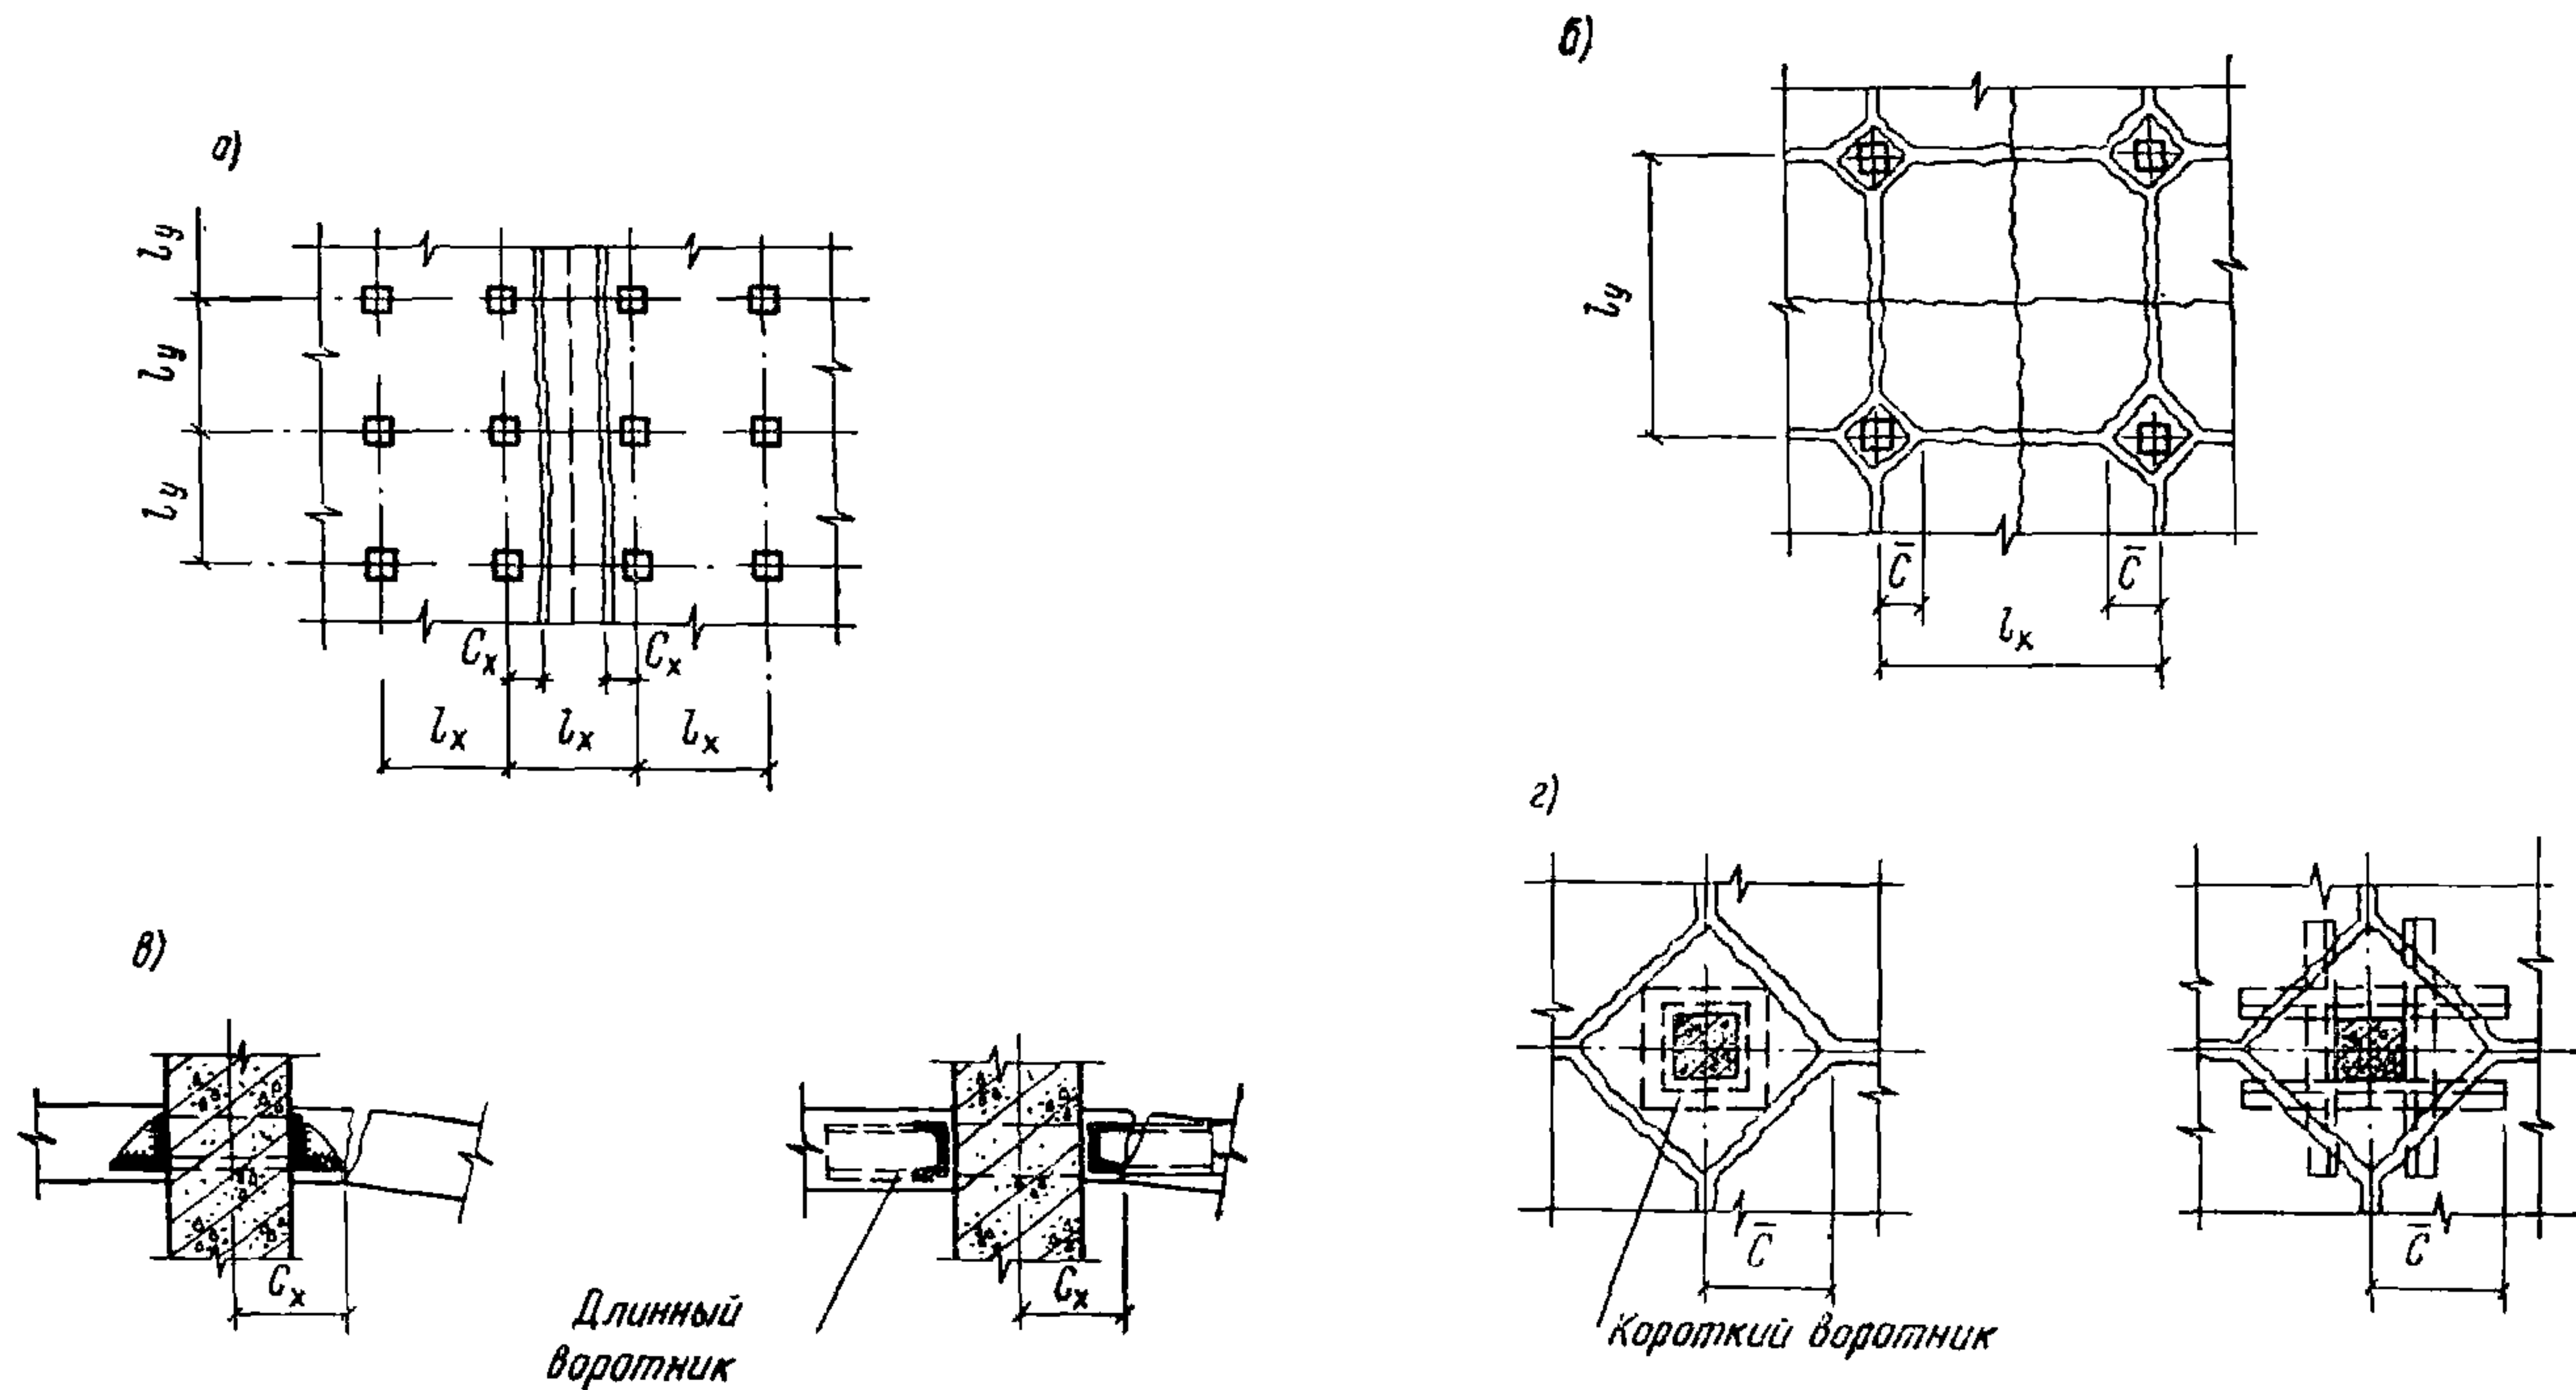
Схемы к расчету плит перекрытий по методу предельного равновесия
